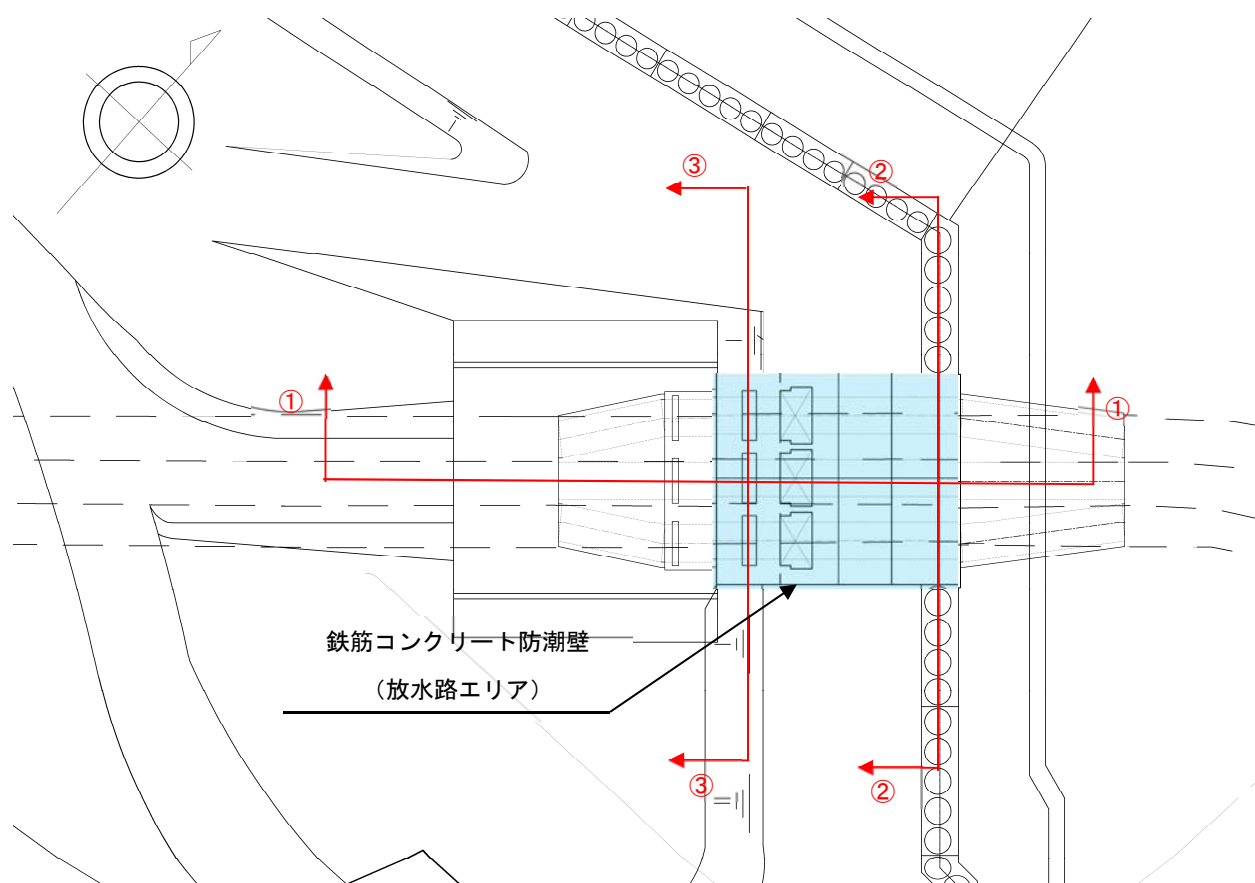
鉄筋コンクリート防潮壁（放水路エリア）の平面図
